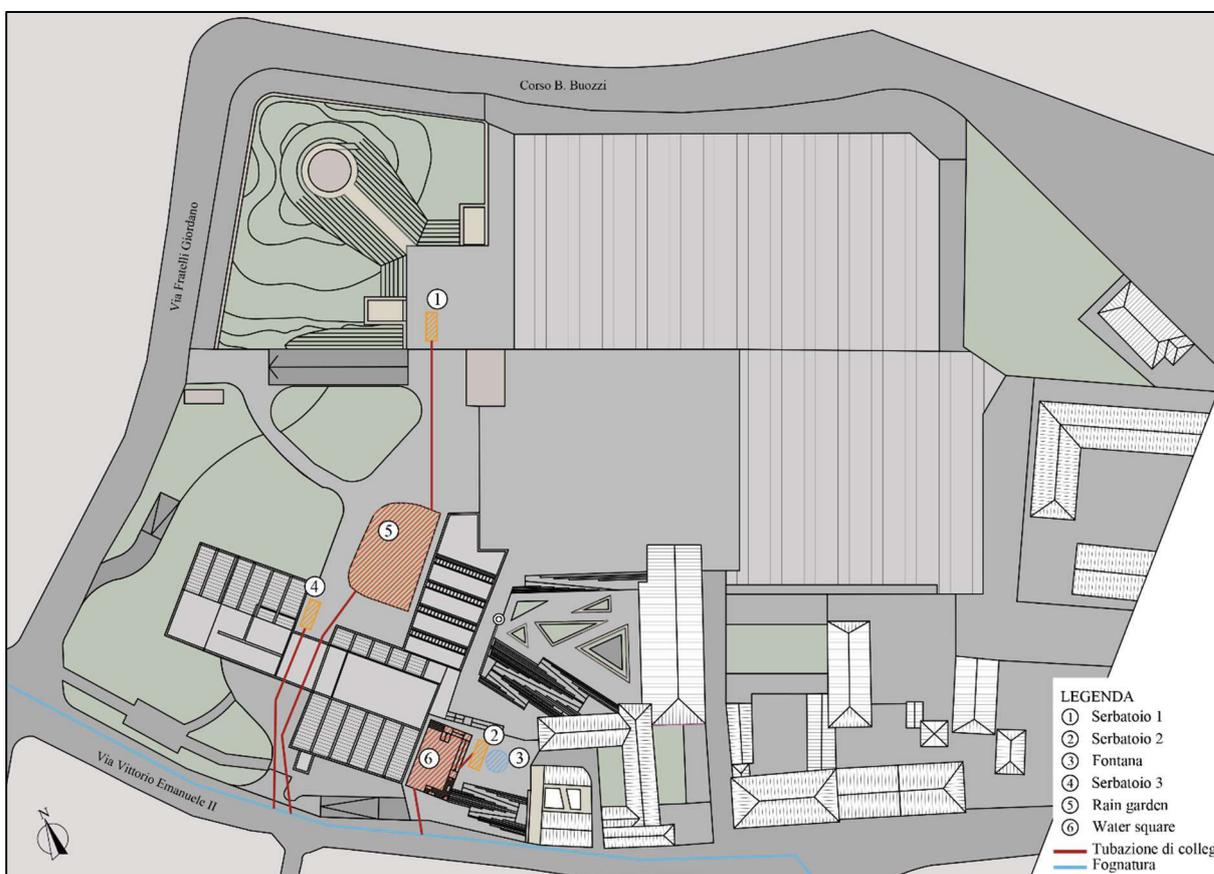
Schema planimetrico degli elementi progettuali (FONTE: www.comune.chieri.to.it)
